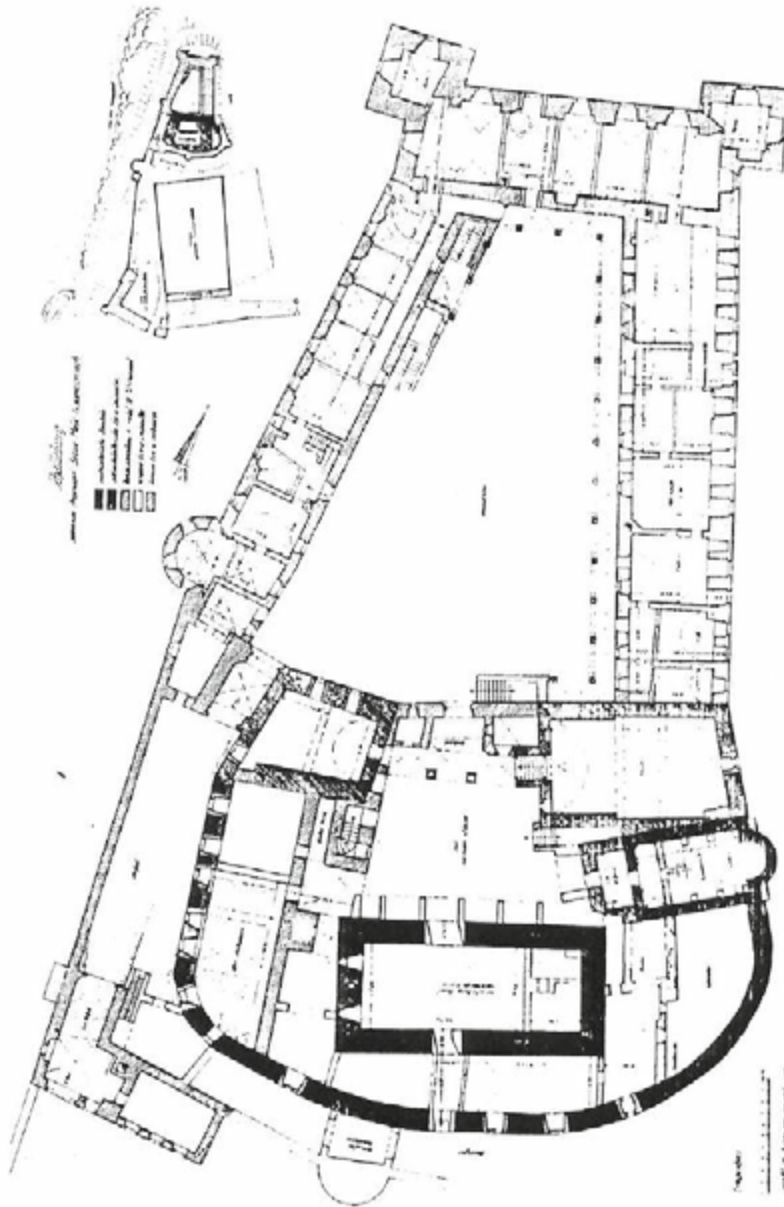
Schloss Schallaburg im Grundriss (1990)
